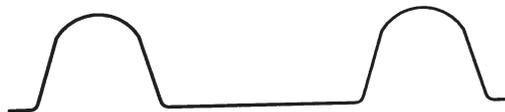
Teil eines typischen Trapezprofils mit gerundeten Obergurten
